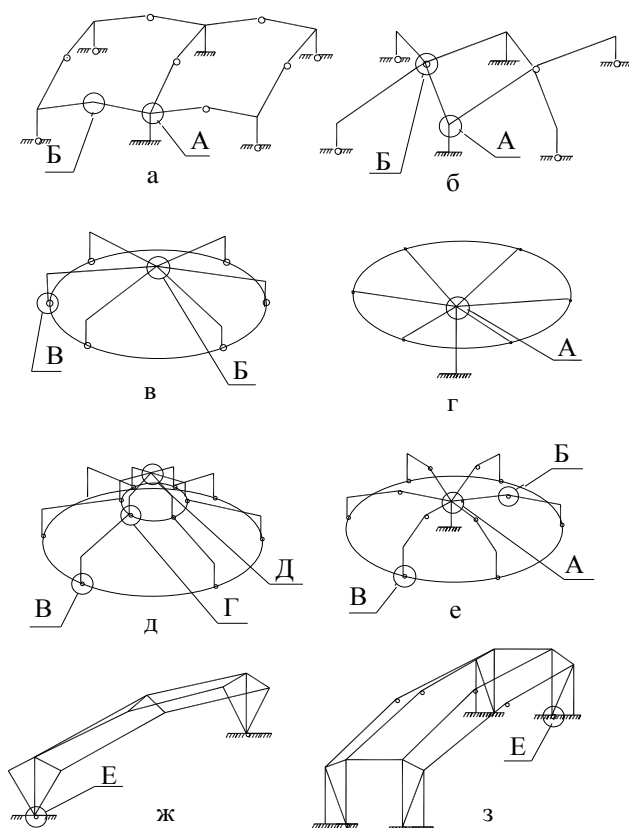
Конструктивні схеми каркасів споруд із залізобетонних рам:
